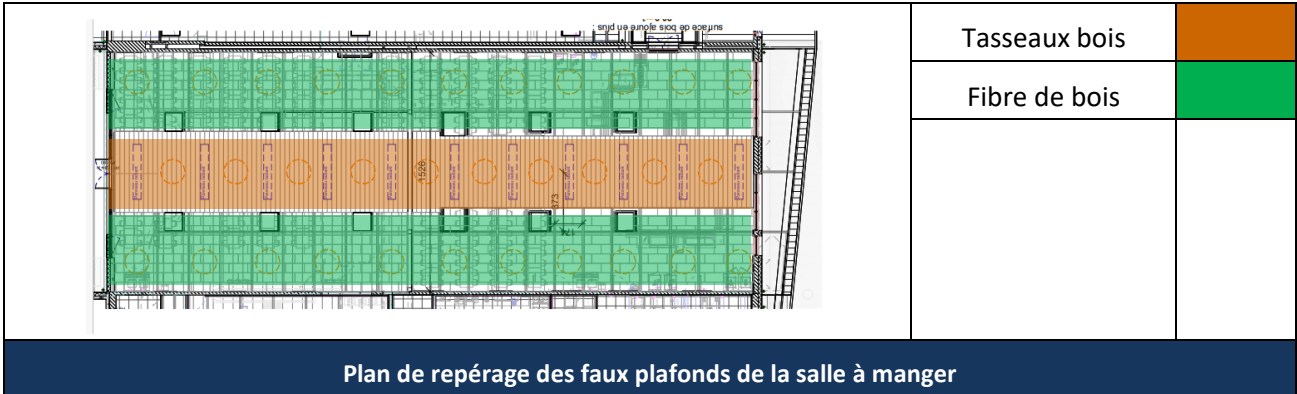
Plan de repérage des faux plafonds – salle à manger
